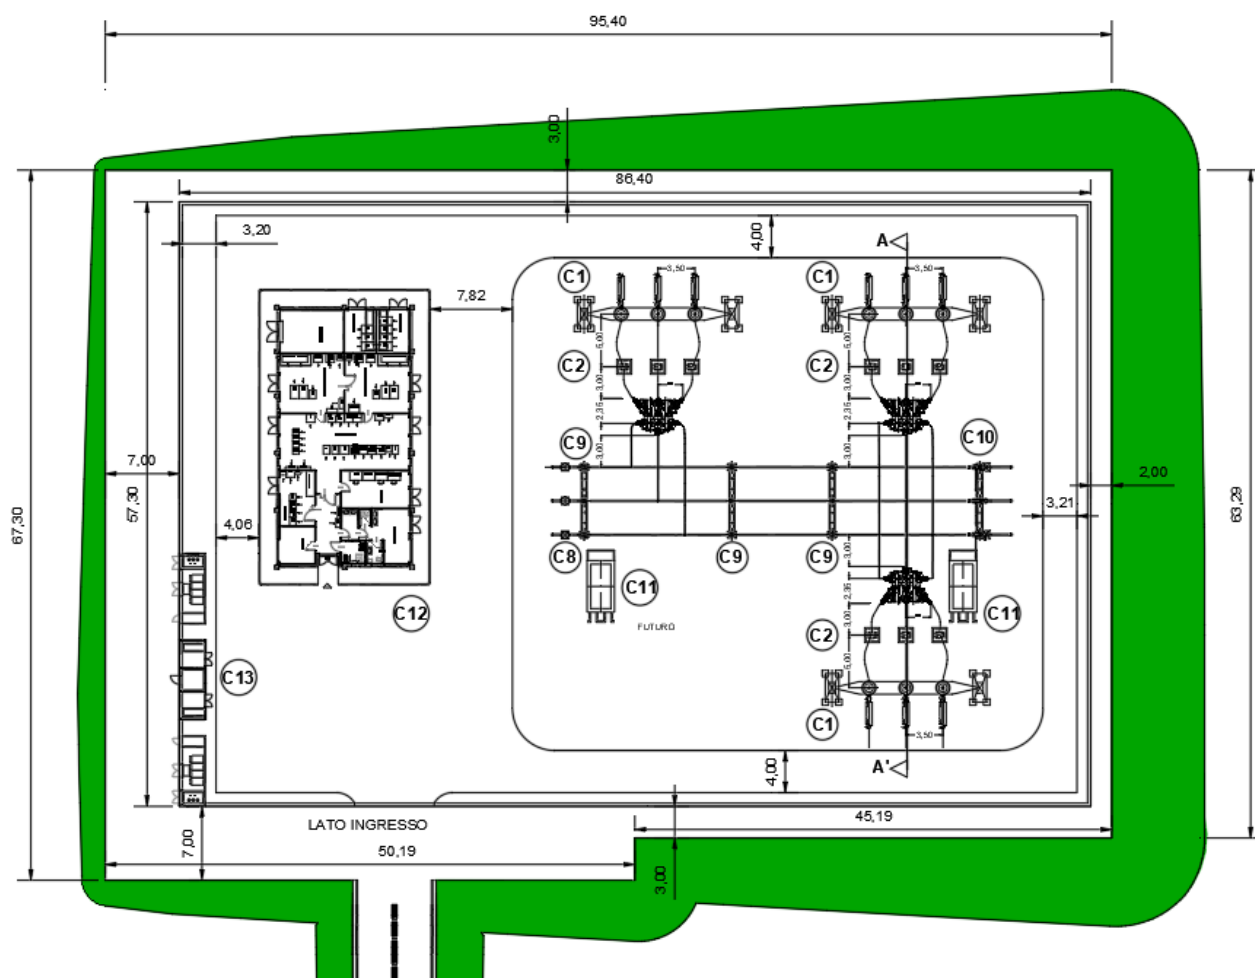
Planimetria elettromeccanica Stazione RTN 220 kV
